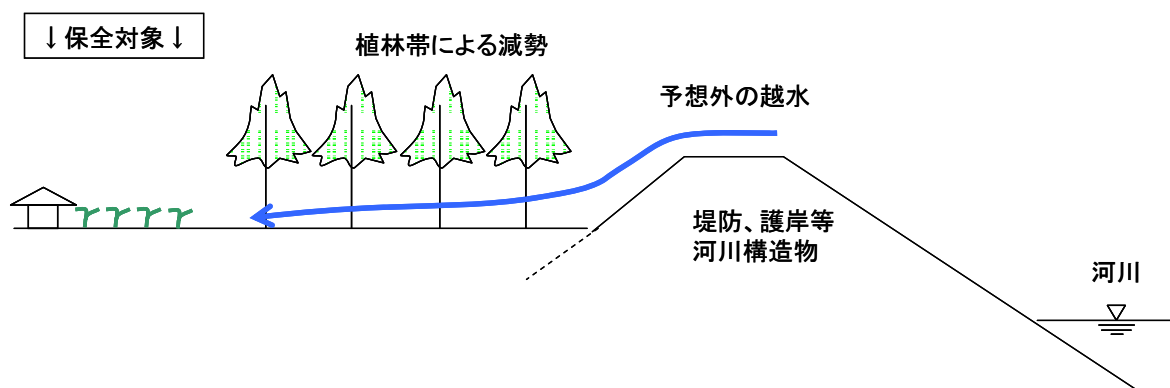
河川構造物沿いの植林 概念図 (タイプ A)
